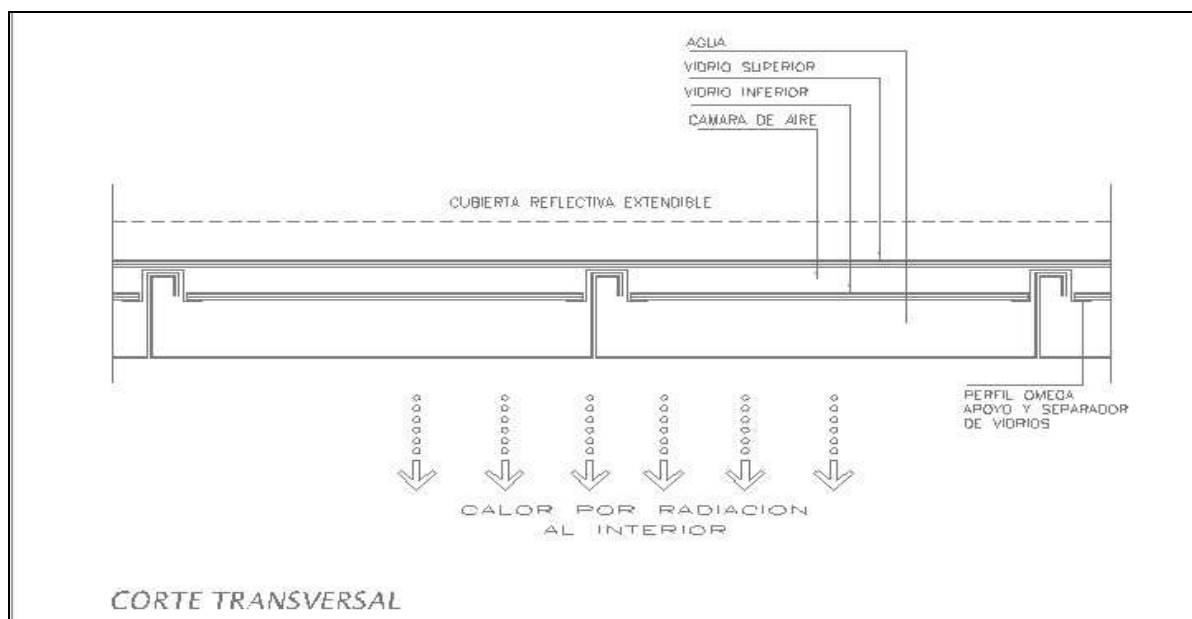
Corte transversal en techo (se observa perfil escalonado de chapa y omega de apoyo a vidrios)
